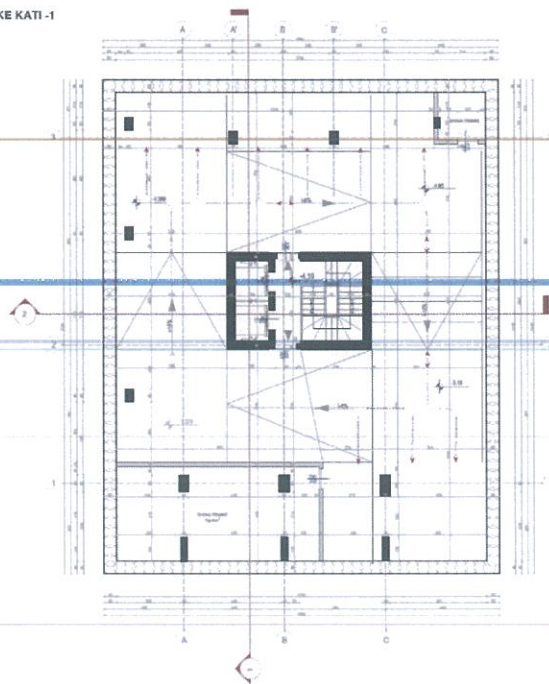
Planimetria e kateve nëntokë (-1)
